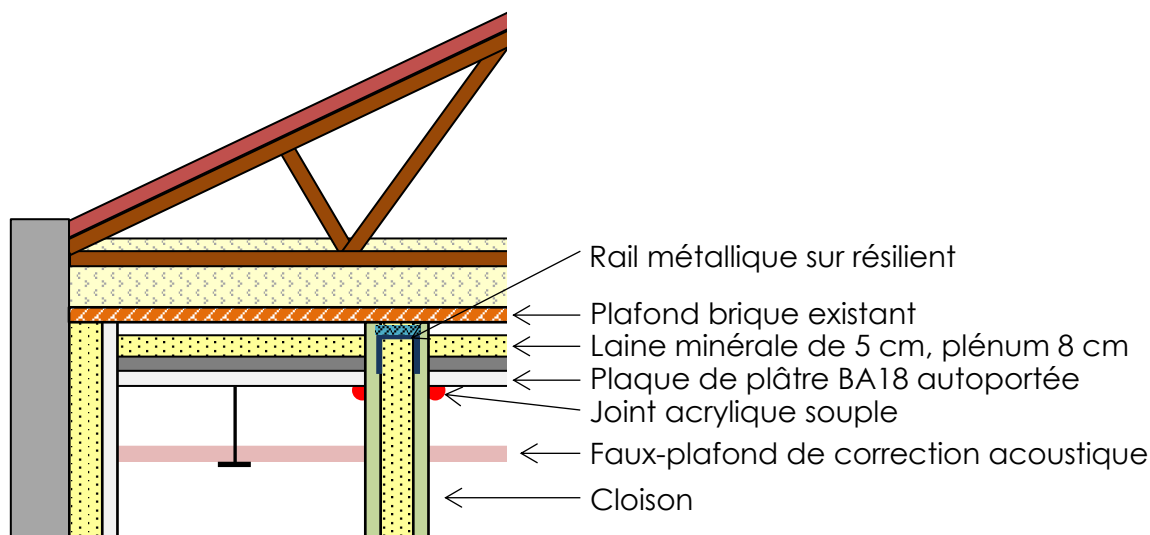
Jonction des cloisons légères avec le complexe de toiture fermette et plafond brique (coupe)
